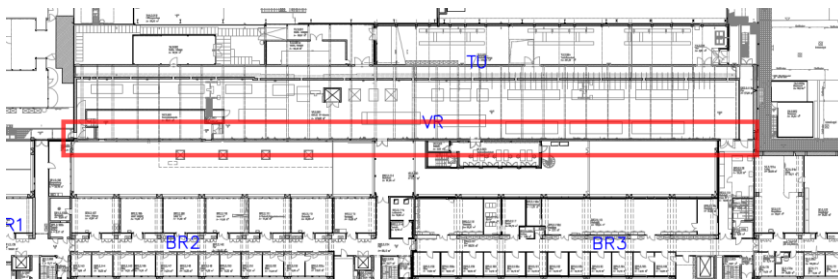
Betrachtete Wand auf dem Grundriss [U-5]
